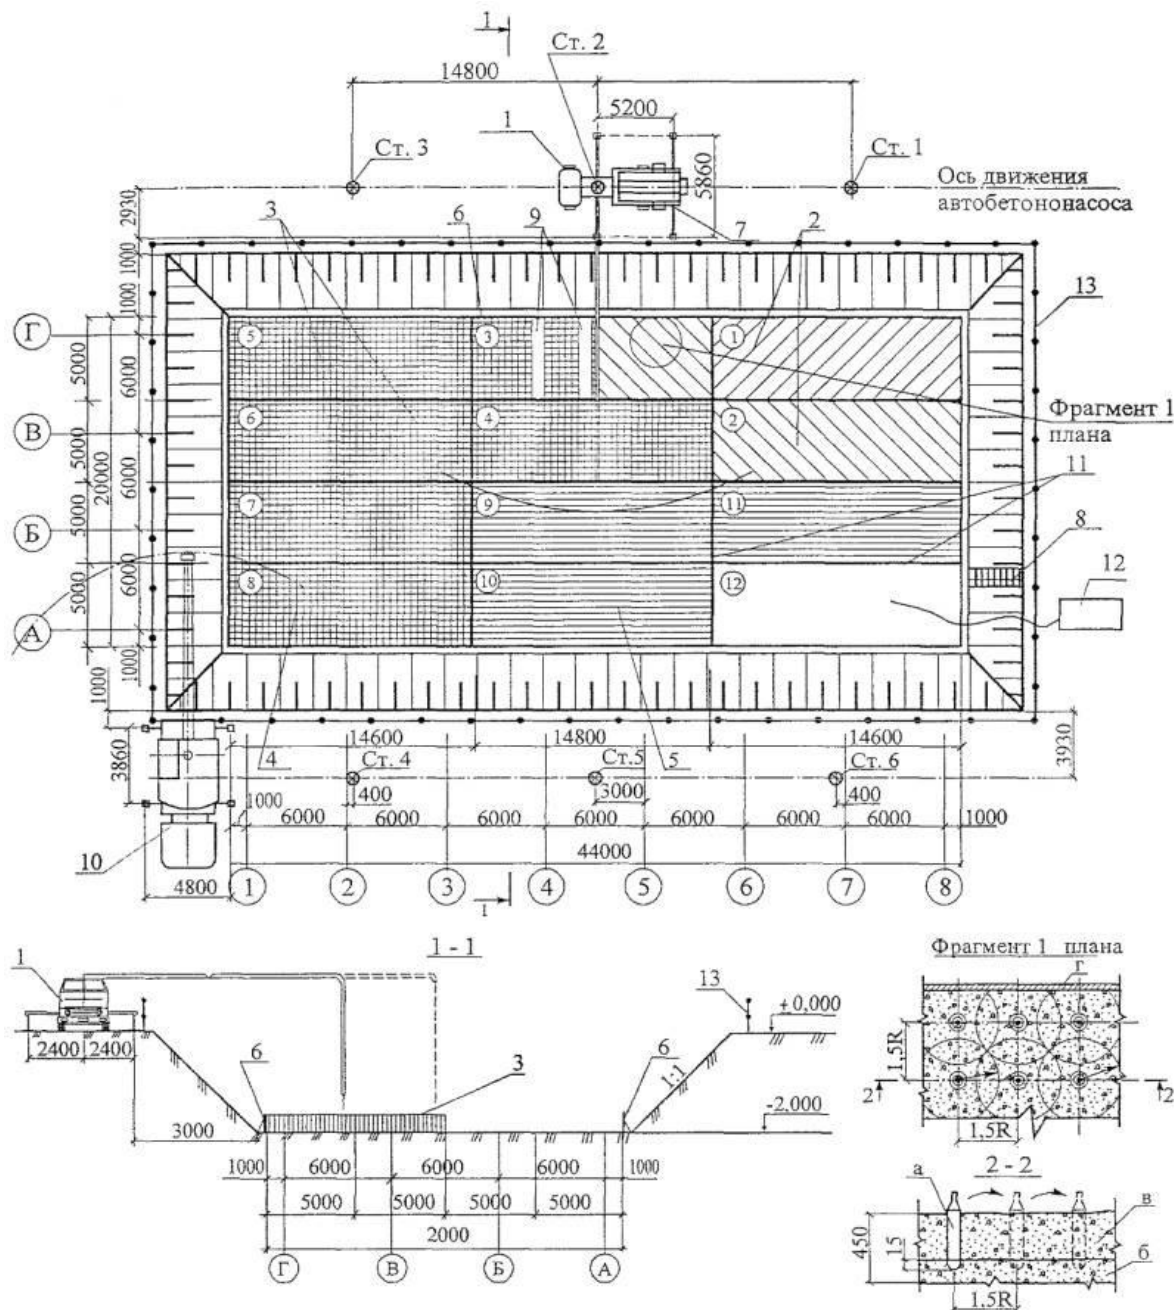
Технологическая схема на бетонирование фундаментной плиты
